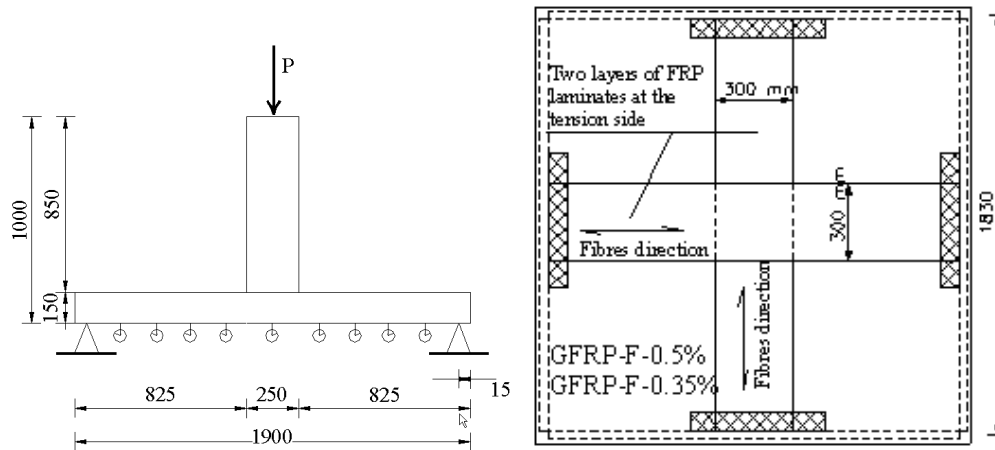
Sistemul de încercare a plăcilor de beton armat [057]
